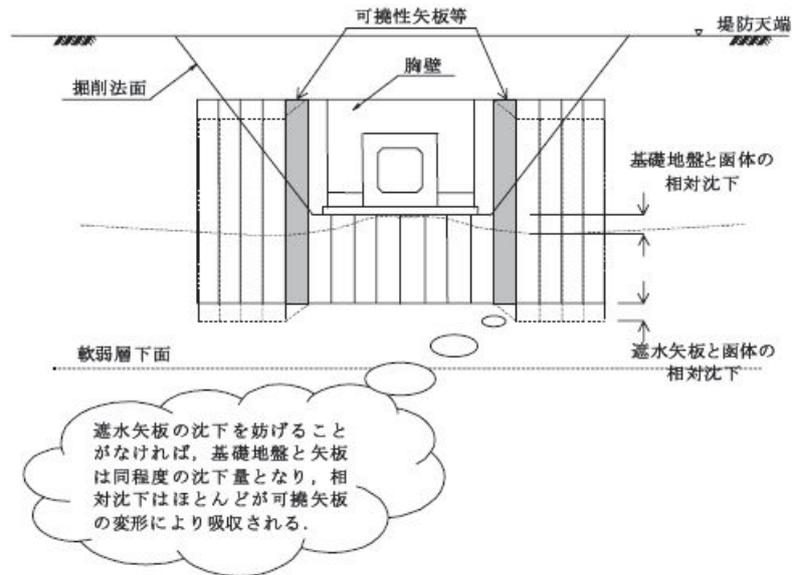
水平方向（堤防縦断方向）の遮水鋼矢板の配置
